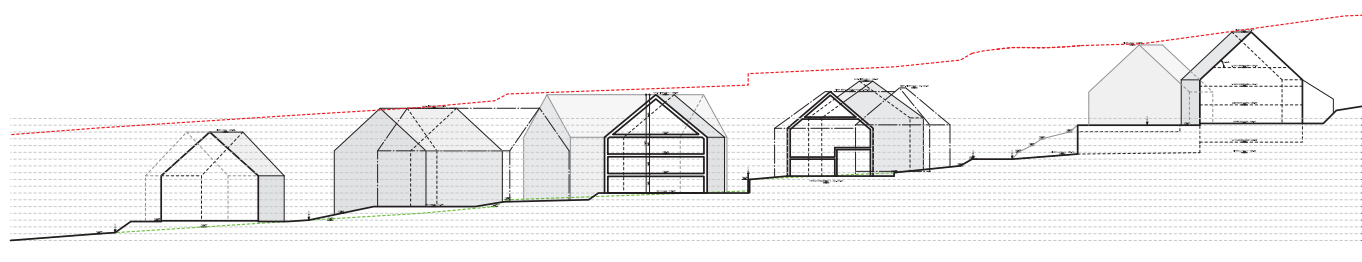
Der Schnittplan zeigt, dass die Gebäude insgesamt nicht höher als die bereits bestehenden Gebäude in Egetswil erstellt werden dürfen. Weil auf die Definition einer Geschosszahl verzichtet wird, können dreigeschossige Gebäude erstellt werden.
